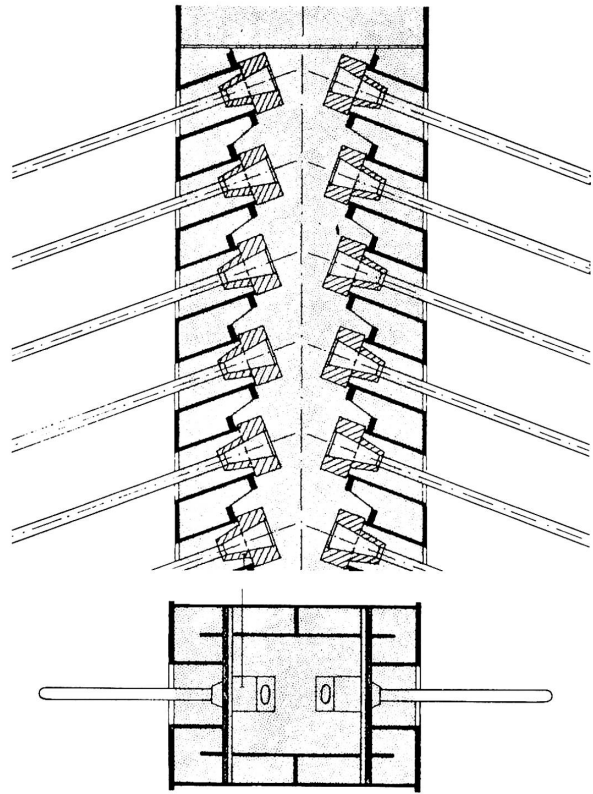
Seilanker im Stahlpylon der Rheinbrücke Bonn-Nord
